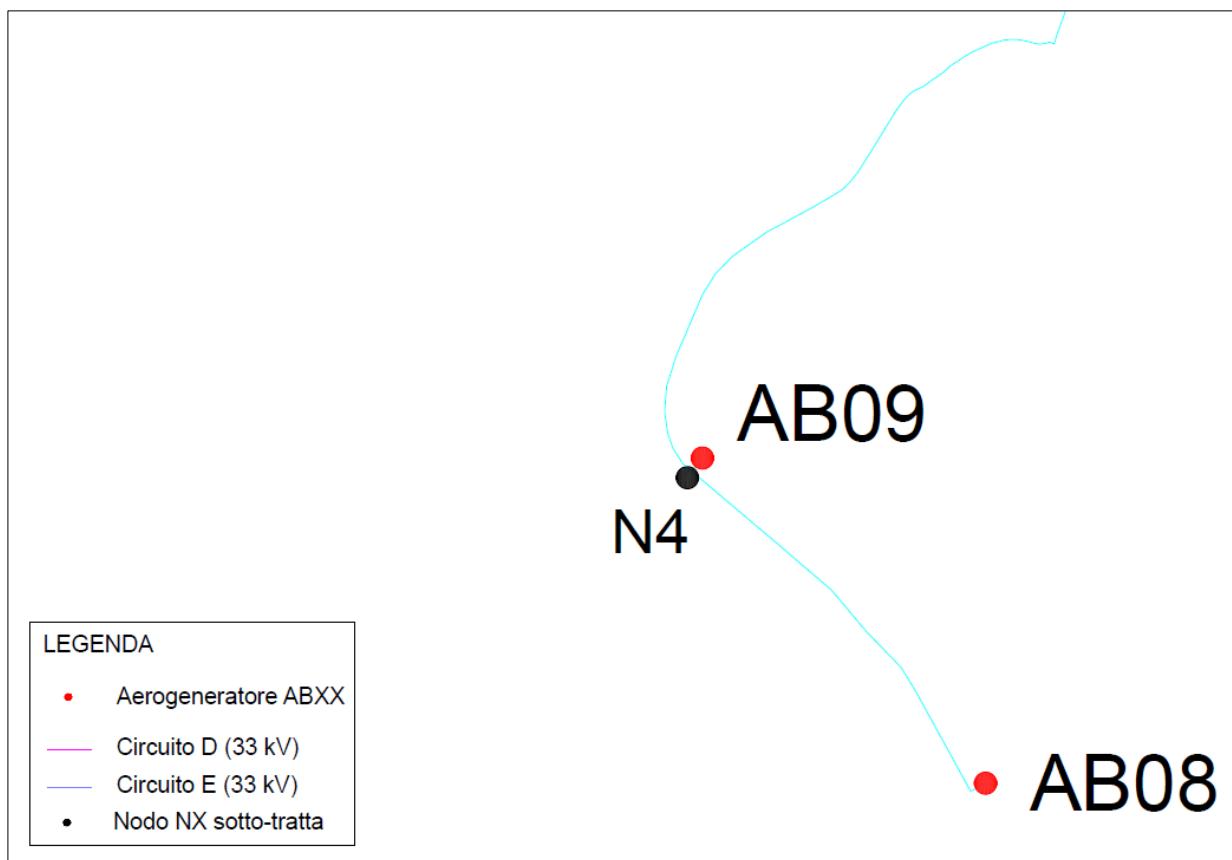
Dettaglio 4 di 4 della planimetria generale di distribuzione linee elettriche
